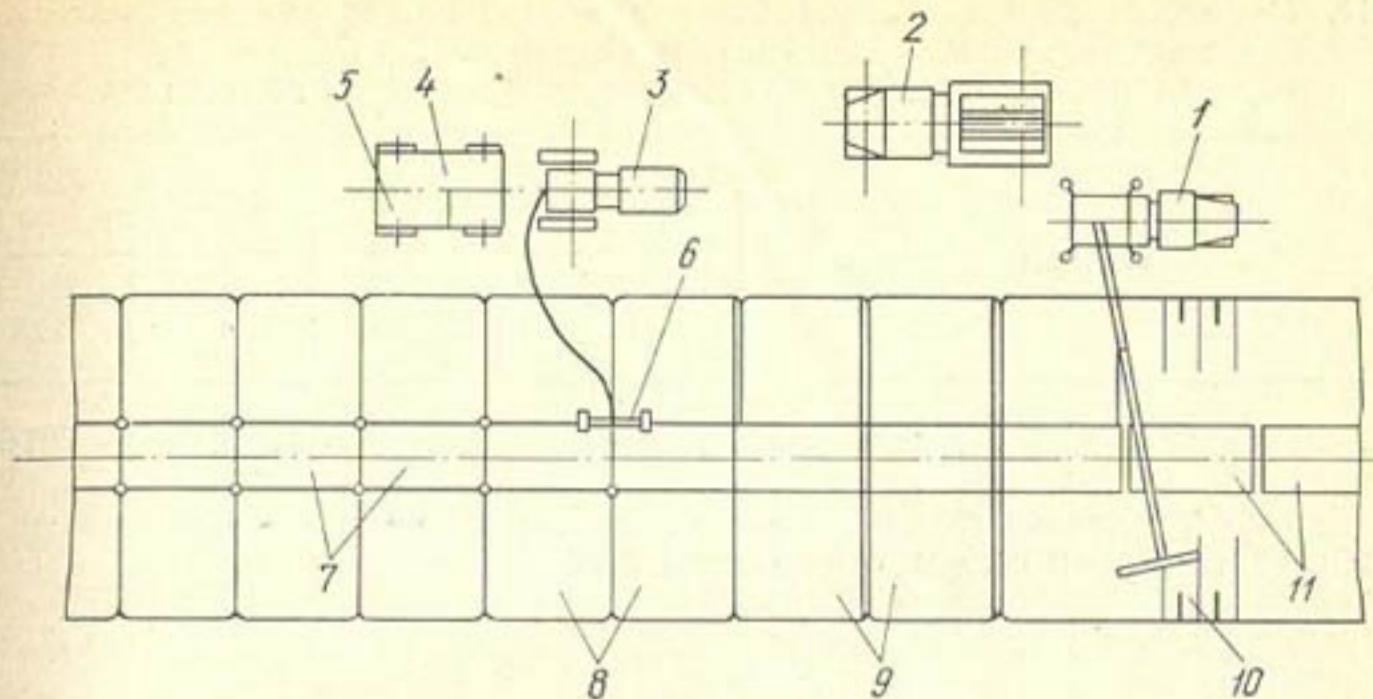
Схема монтажа сборных облицовок оросительных каналов с обжатыми швами на гидроизоляционных прокладках:
